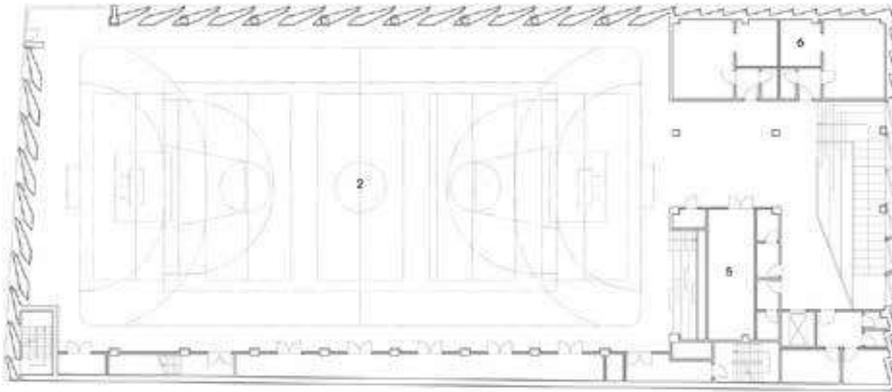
Sundbyøster Hall II, Grundriss Sporthalle
